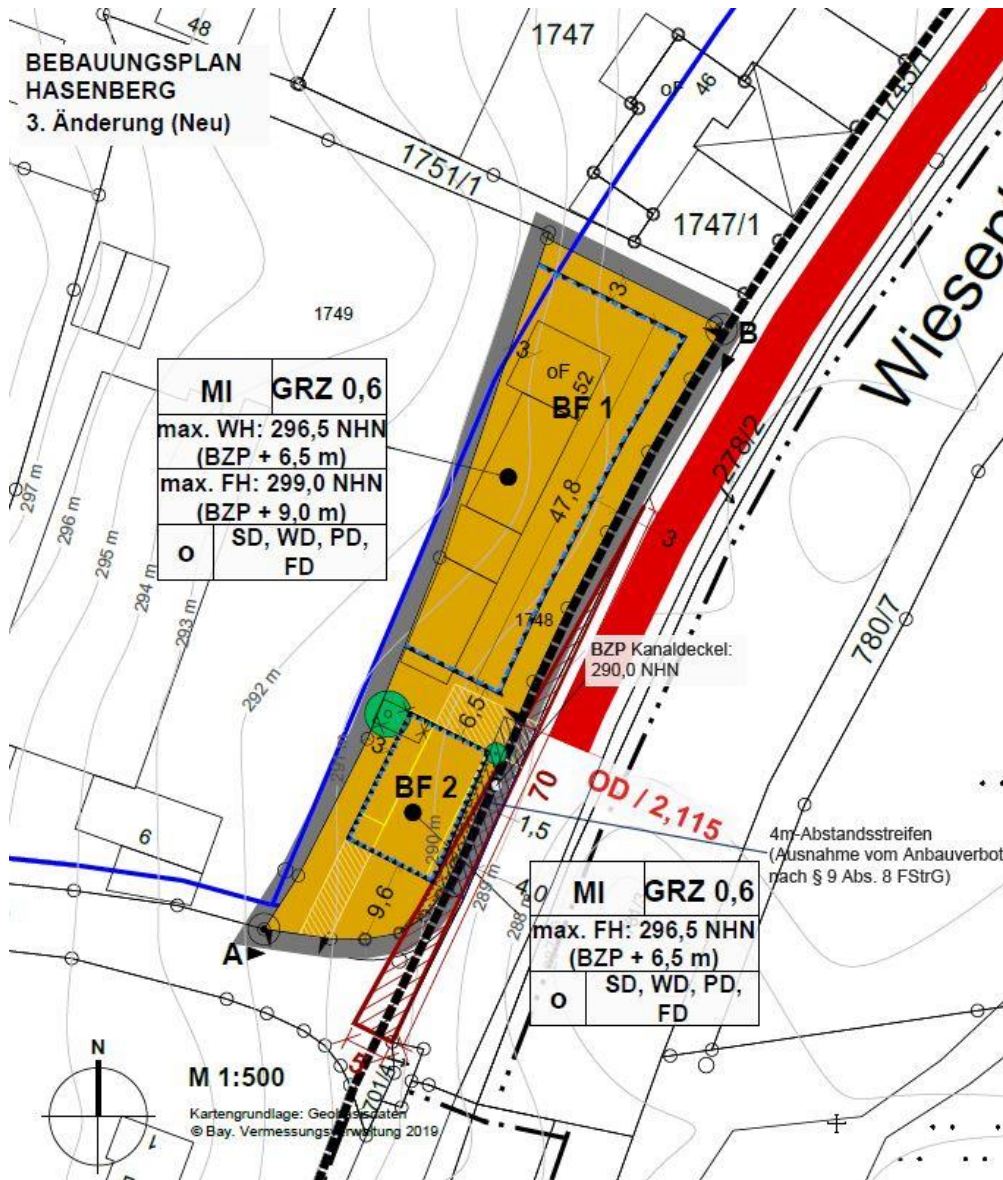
Ausschnitt Entwurf, 3. Änderung des Bebauungsplans „Hasenberg“ Stand: 20.07.2020
